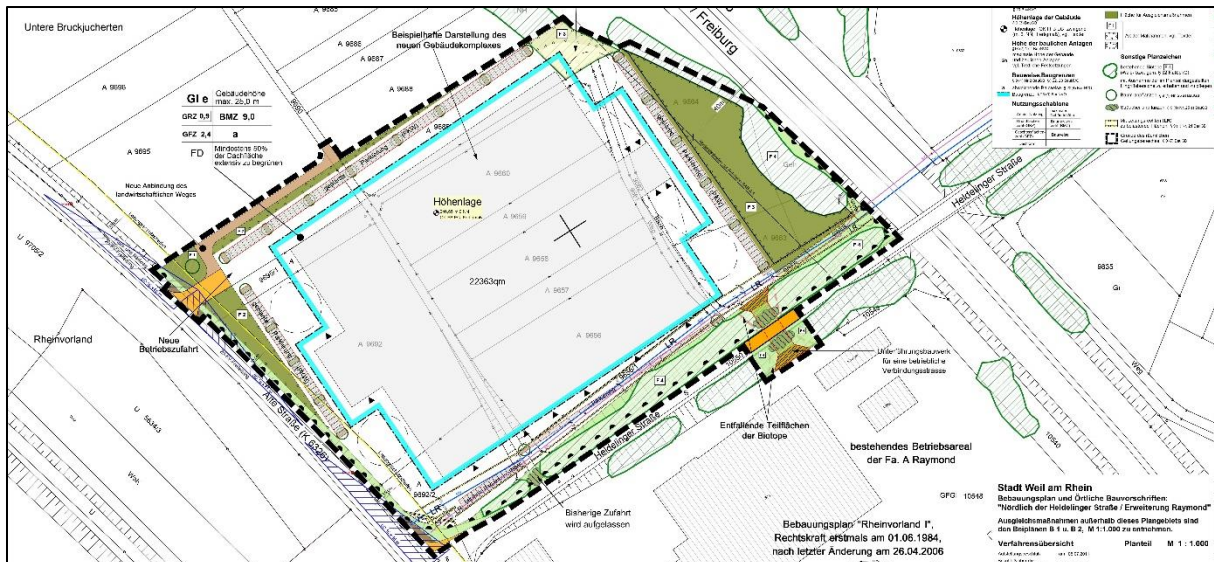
Bebauungsplan „Nördlich der Heldelinger Straße – Erweiterung Raymond“ Quelle: Stadt Weil am Rhein, unmaßstäblich
